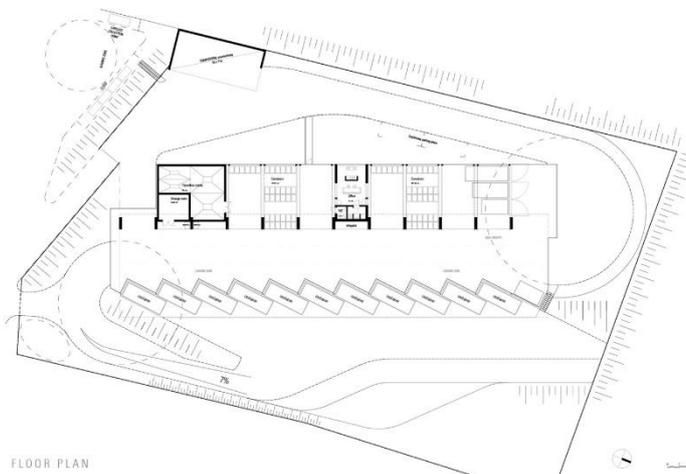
Denah Pusat Daur Ulang Smestad
